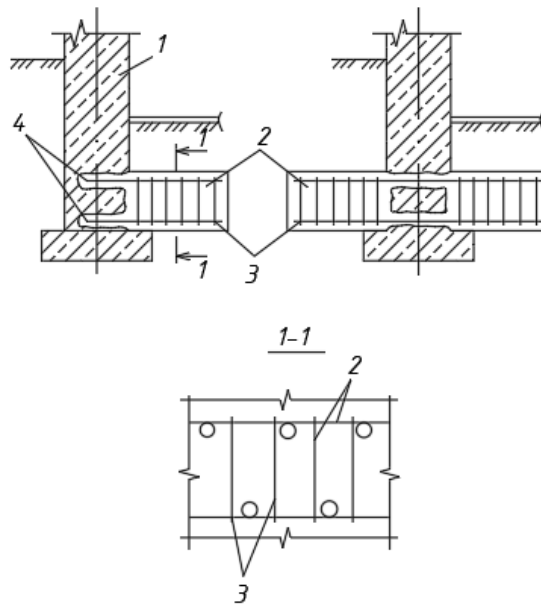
Підсилення стрічкових фундаментів нарощуванням:
